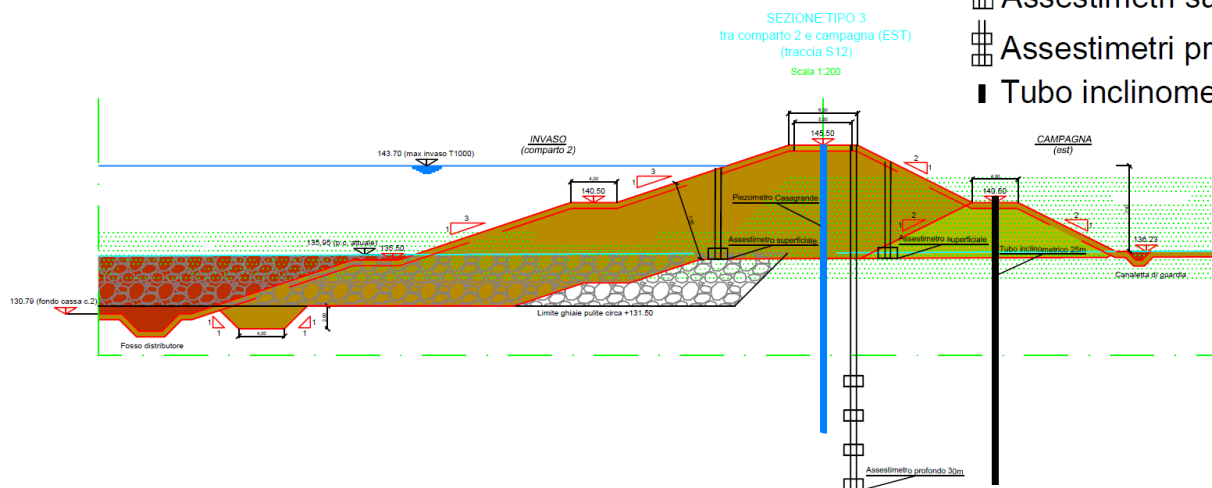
Schema d'ubicazione della strumentazione per il monitoraggio (Sezione tipo 3)
